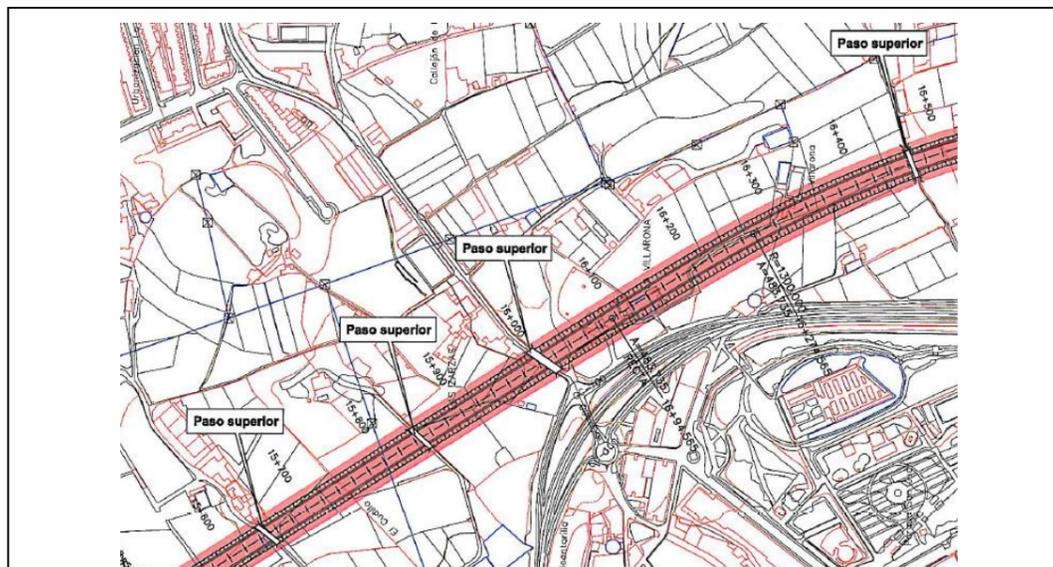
Imagen planta de 4 pasos superiores previos a la estación de Telde PTE-21
